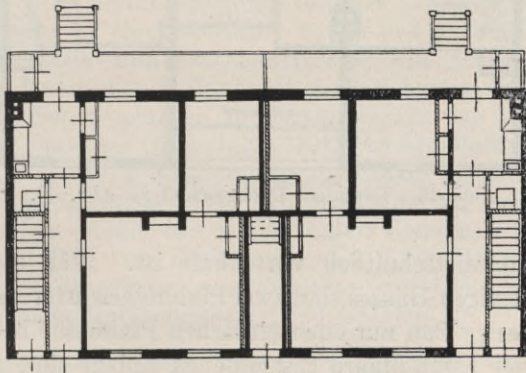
Kleinwohnungen zu Abb. 43, Grundriß Erdgeschoß.
